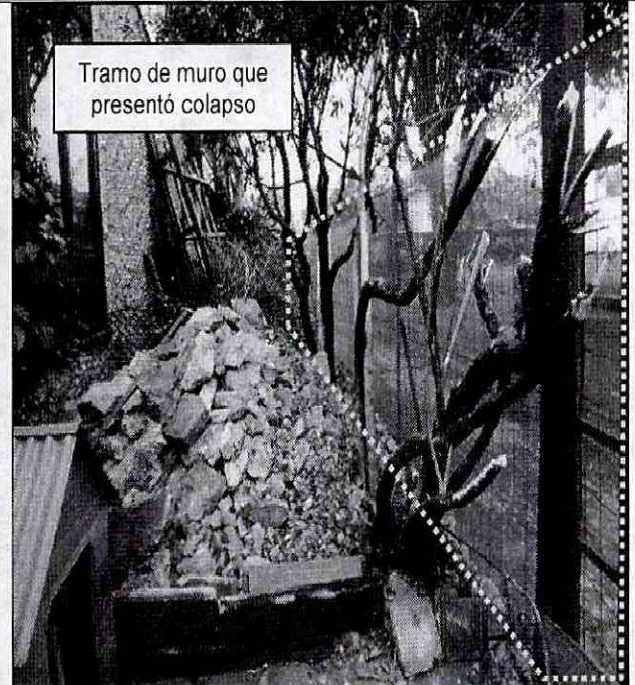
Vista del sector de la Carrera 45 A y la Carrera 49 B, entre la Calle 102 A y la Calle 104 A, donde se localizan las viviendas evaluadas en el Barrio Catastral Estoril de la Localidad Suba.
